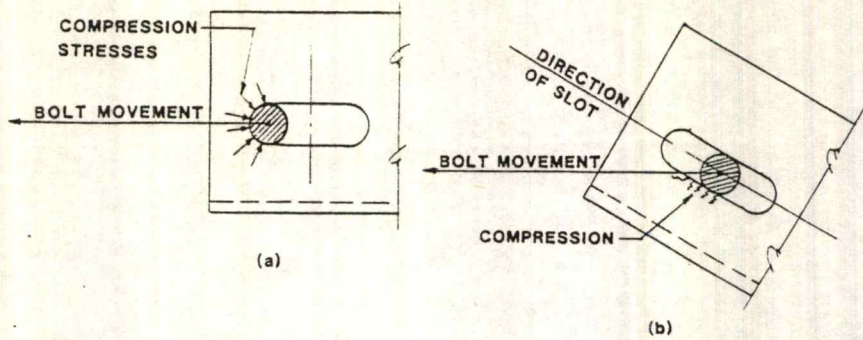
การสร้าง expansion joints ใหม่ได้ใช้ sliding plates เพื่อให้เกิดการเคลื่อน
